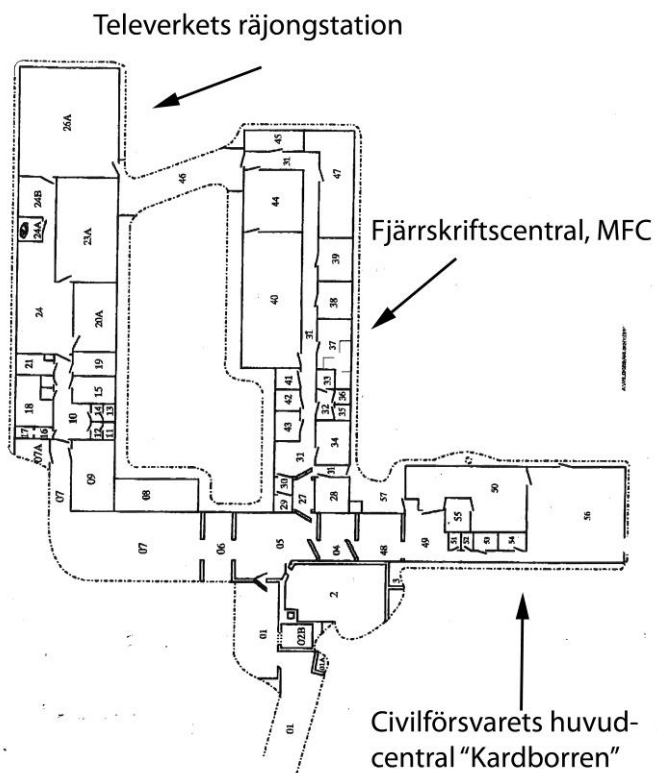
Planritning över bergrummet i Staglabergget med ursprungliga funktioner fördelade på tre tunnlar.
